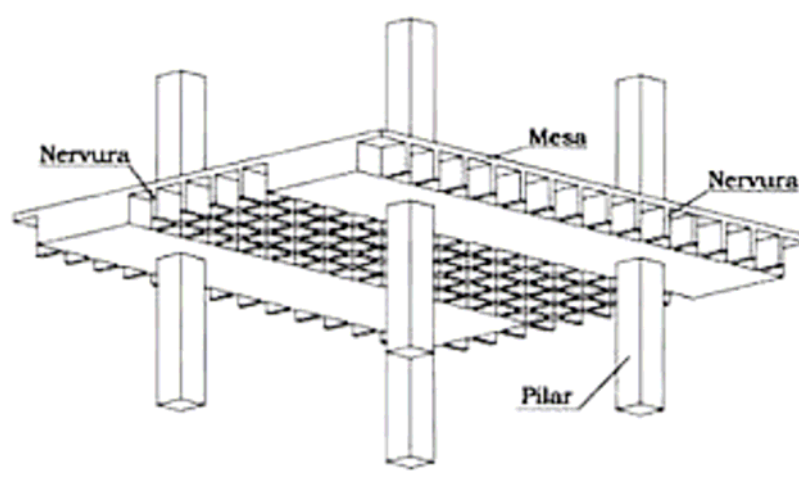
Laje nervurada lisa apoiada sobre pilares com viga-faixa
